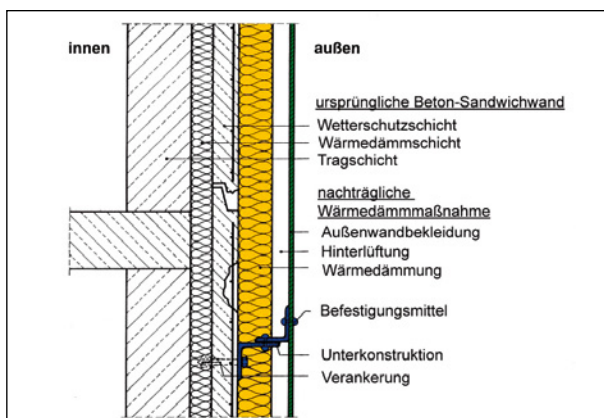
■ Beton-Sandwichwand ohne konventionelle Betoninstandsetzung, aber mit nachträglicher Wärmedämmung in Form einer hinterlüfteten Außenwandbekleidung
